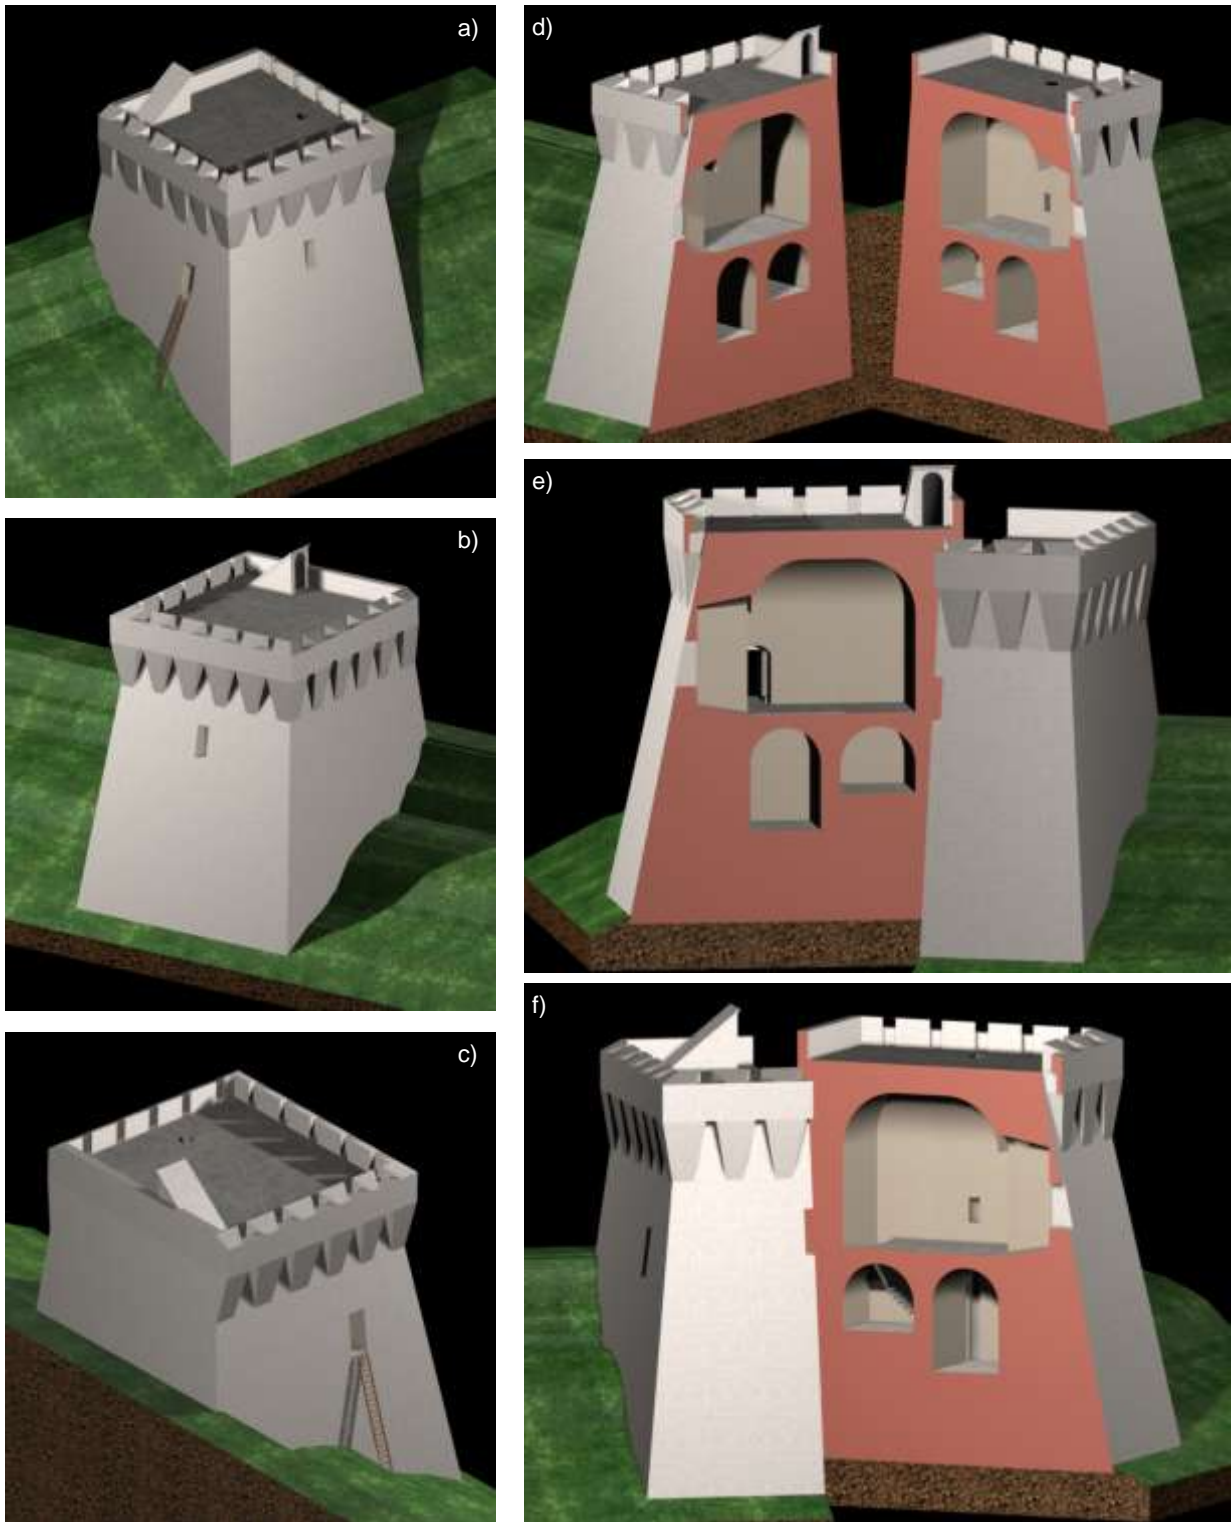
Modello digitale dell'ipotesi di tipologia originaria : a) vista assometrica Nord-Ovest; b) vista assometrica Sud-Ovest; c) vista assometrica Nord-Est; d)- e) - f) Spaccati assometrici.
